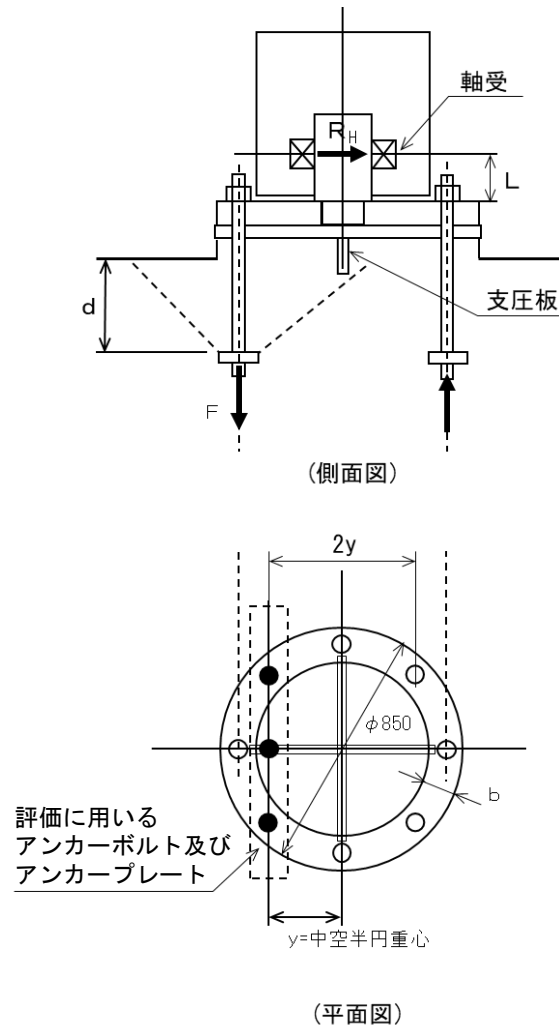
下部支承 (アンカーボルト) 及び下部支承 (コンクリート) の評価イメージ図
